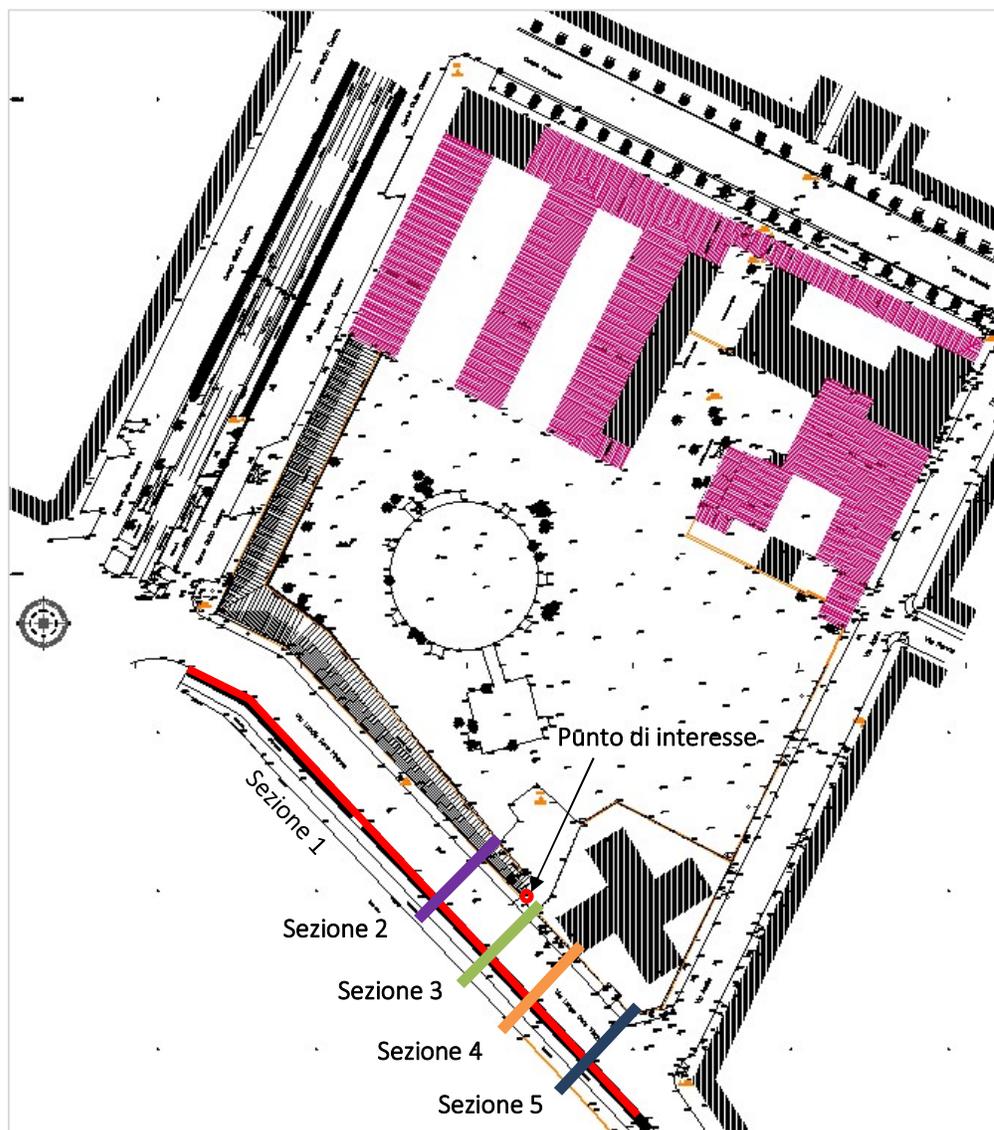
Planimetria Rilievo area di intervento Stato di Fatto e ubicazione Sezioni
